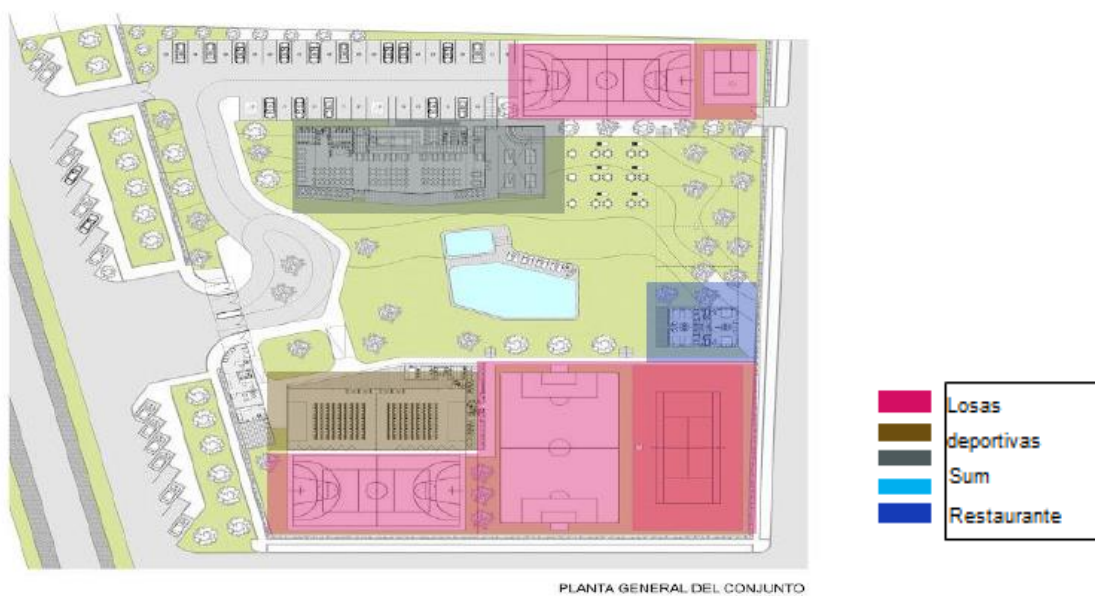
Primera Planta con la Descripción del Sistema Espacial
